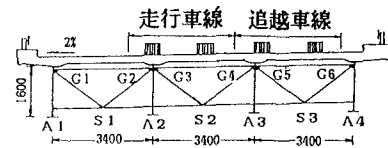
垂直補剛材と上フランジとの溶接部近傍に生ずる亀裂
